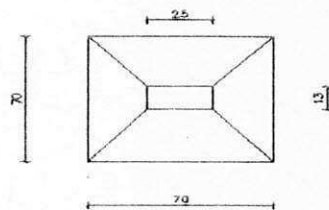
Exemplo de detalhe de Pilar e Fundação do armazém.
